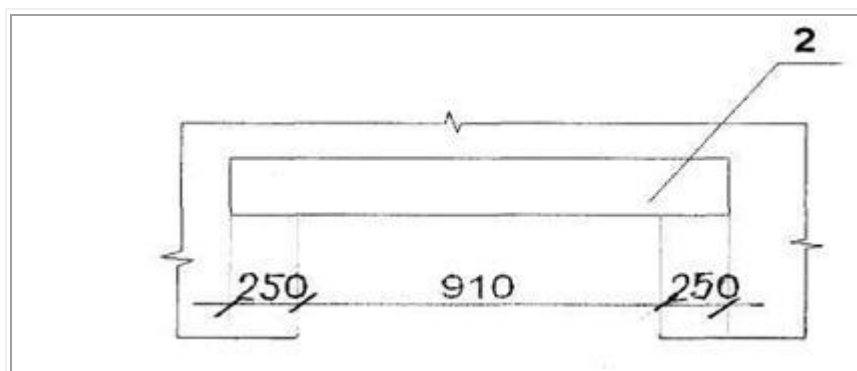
Схема опирания несущей перемычки над проемом
